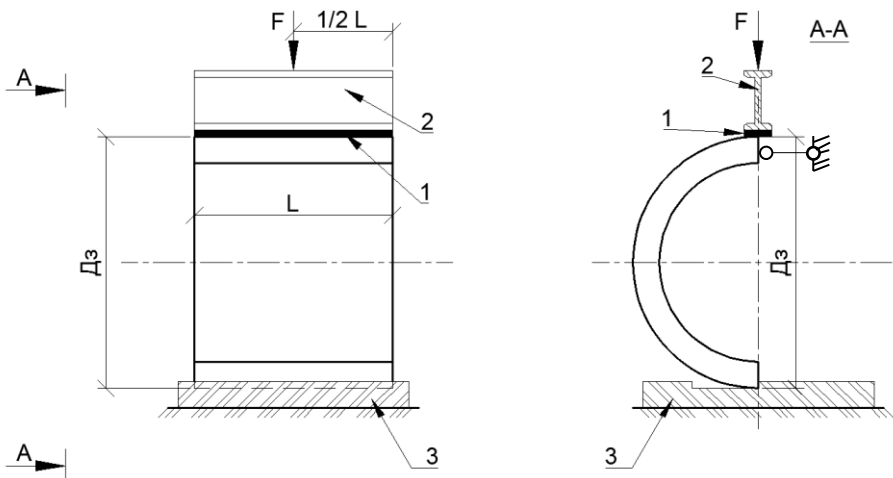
Схема випробування лотка водовідведення: 1 – гумовий килим або цементний розчин; 2 – металева траверса; 3 – нерухома основа
